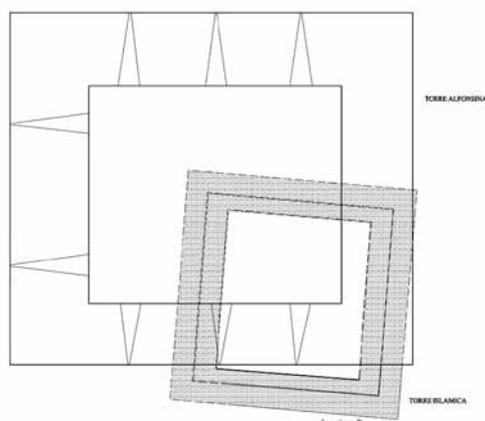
Planta de la torre exenta 1 comparada con la planta de la torre Alfonsina, mandada construir por el rey Alfonso X.
